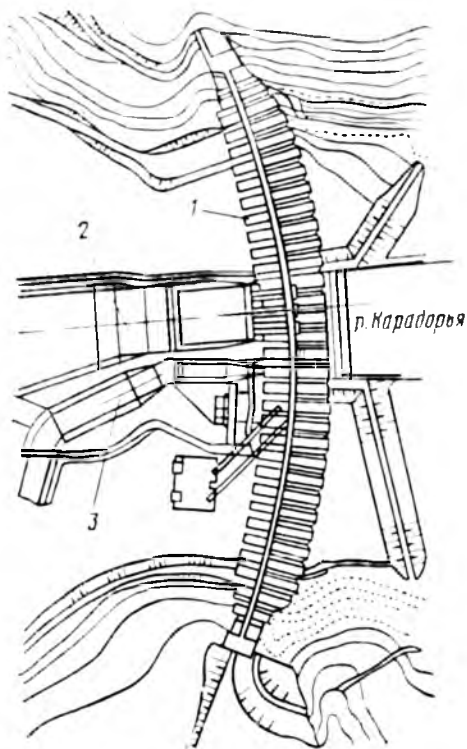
Схема компоновки Андijanского водохранилищного гидроузла на р. Карадарья: 1 — плотина; 2 — водосброс; 3 — водовыпуск.
